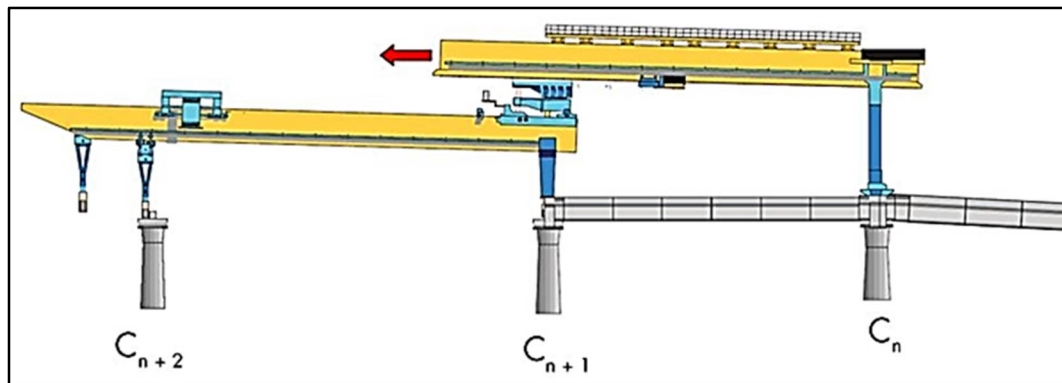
Avance de la viga lanzadora, Fase 1: avance de la viga superior sobre la viga inferior (1)
